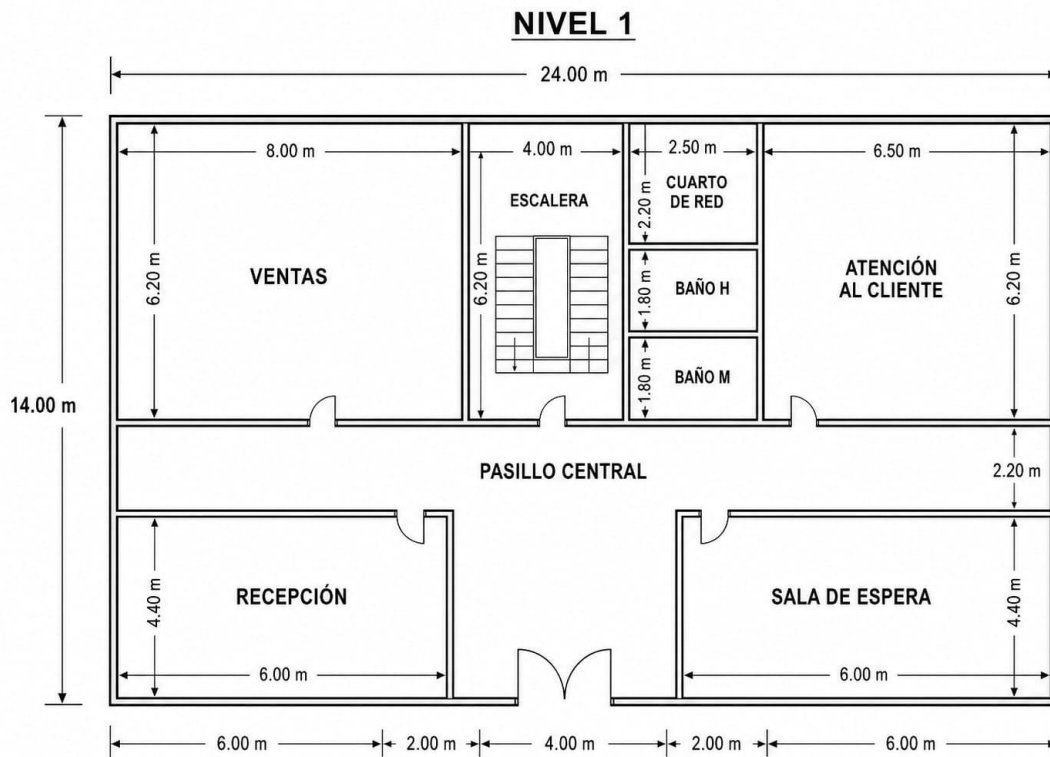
Plano arquitectónico original — Nivel 1 (sin anotar).
